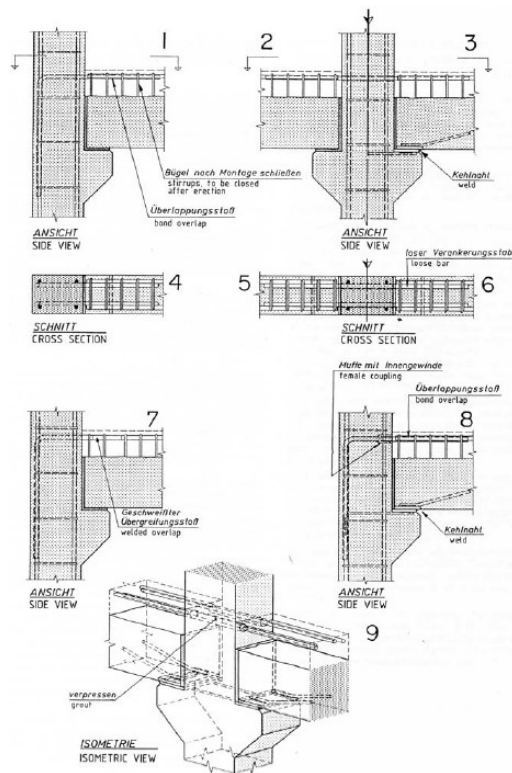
Ligação por consolo de betão e armadura comum (Stupré, 1981)
